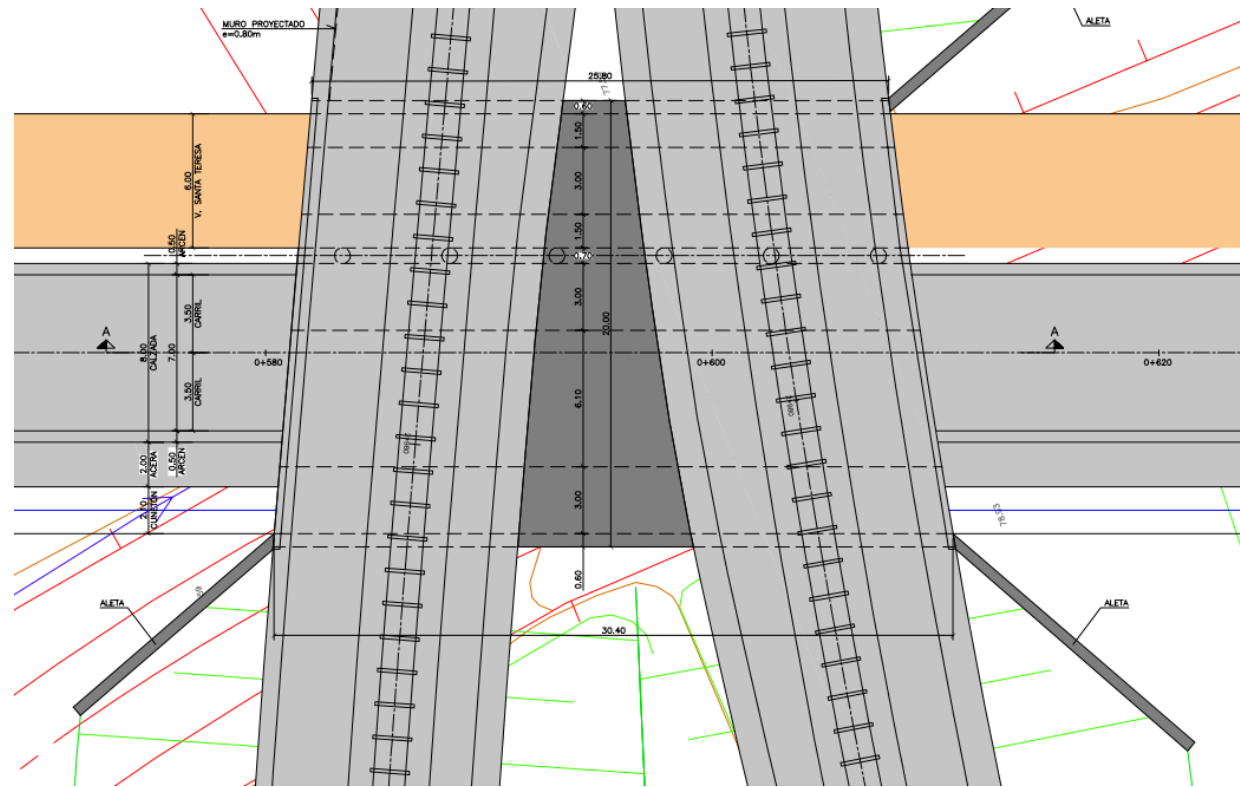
PLANTA PI ACCESO ESTACIÓN DE ELCHE Y COLADA DE SANTA TERESA P.K. 2+990
